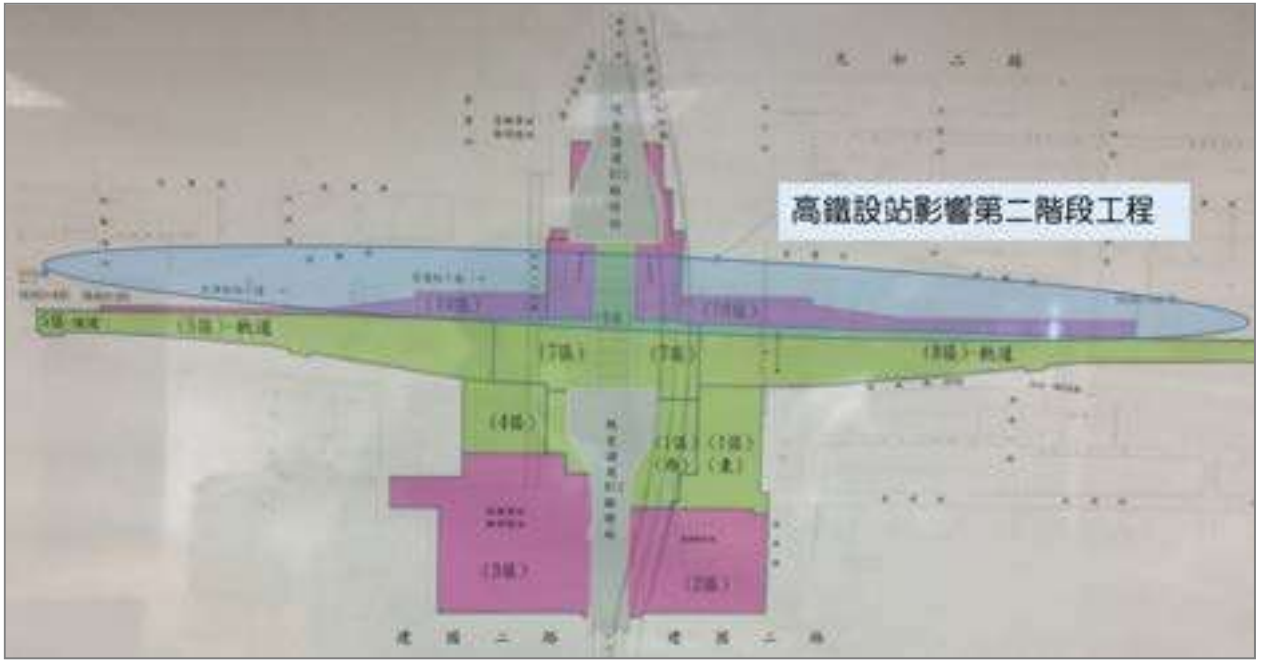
原臺鐵高雄車站分期分區施工構想示意圖及受高鐵影響範圍示意圖
